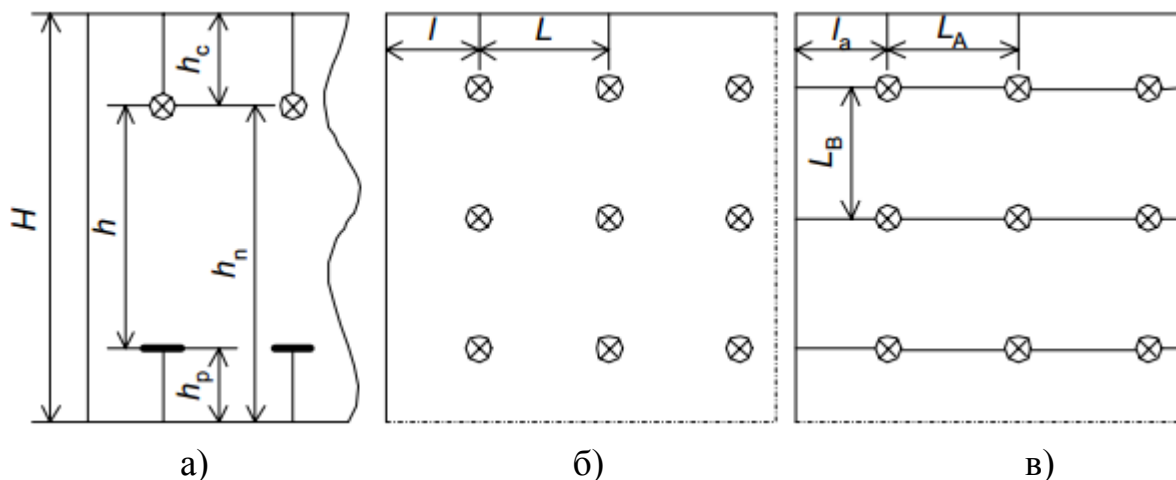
Схемы расположения светильников: а – в разрезе; б, в – в плане
